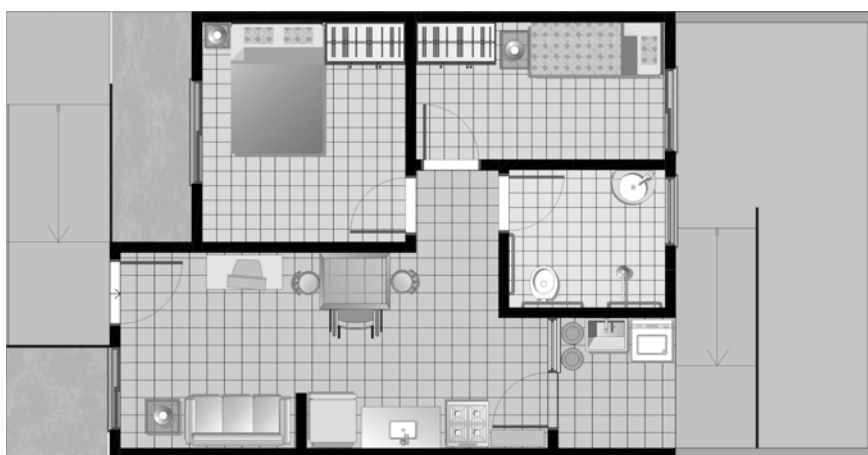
Planta Baixa da Casa Acessível - UHPPD
